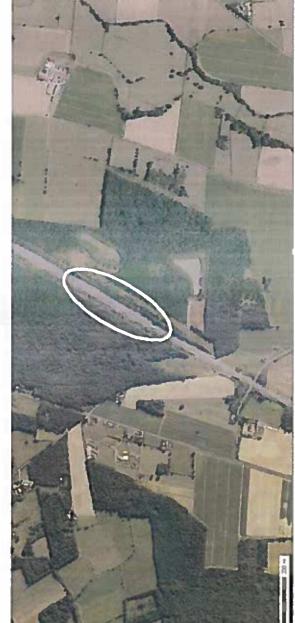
Photographie aerienne – Zone entre PK 98.0 et 98.5
